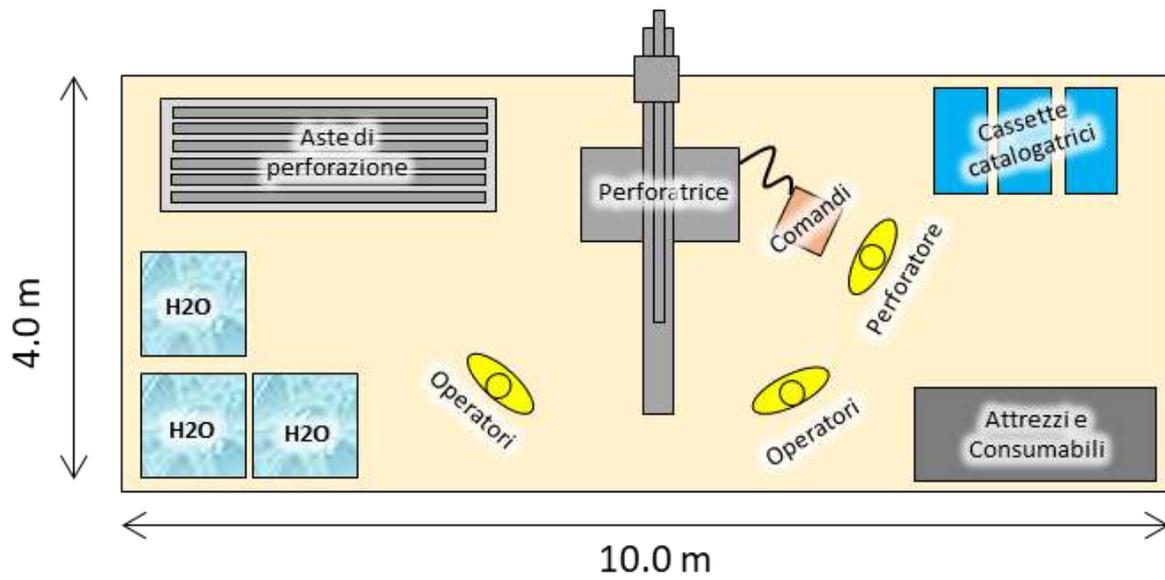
Schematizzazione piazzola di lavoro Area Santa Barbara
